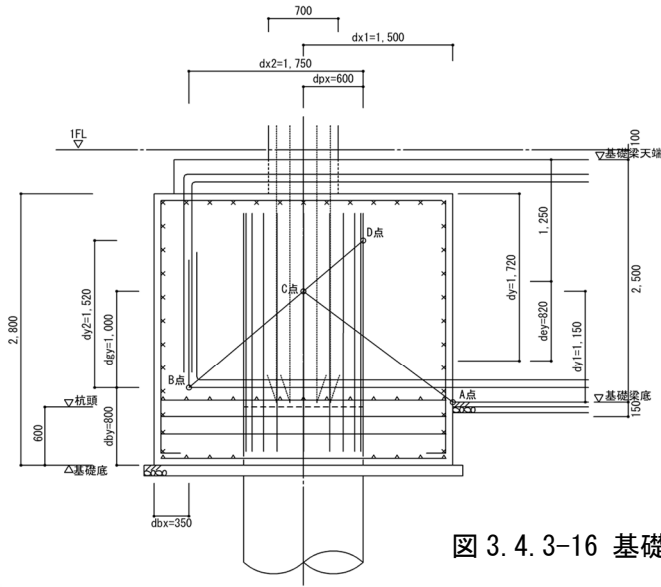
基礎・基礎梁配筋と破壊面
